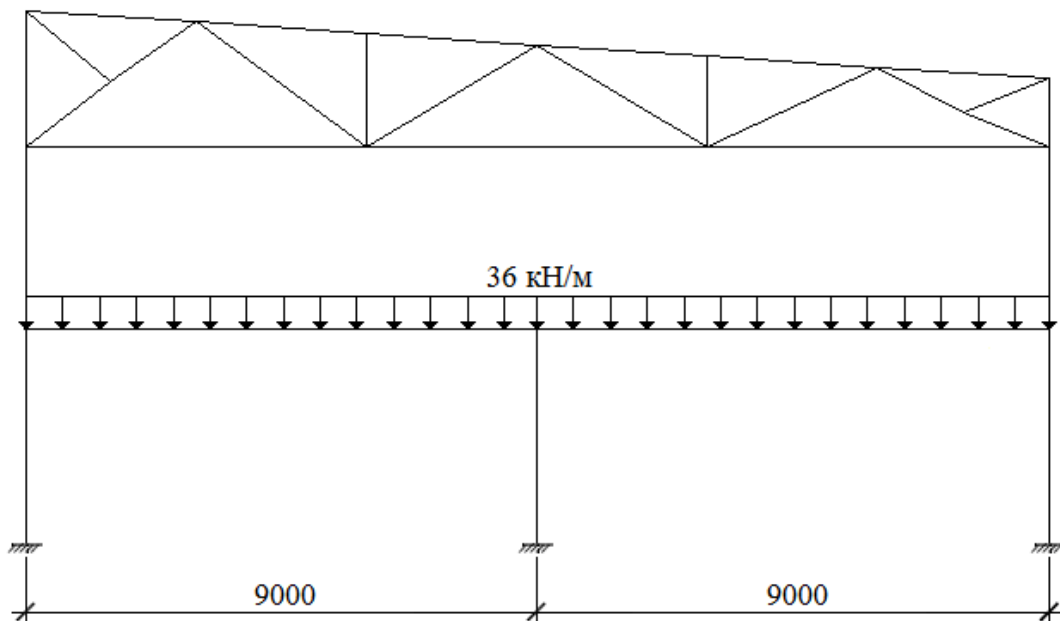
Кратковременная нагрузка на перекрытия
